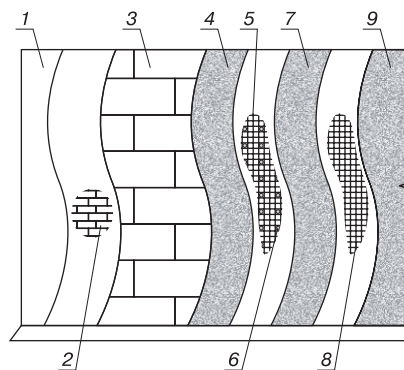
Утепление стены здания по системе «Fassolit Mineral»: 1 – внутренняя штукатурка; 2 – несущая кирпичная стена; 3 – теплоизоляционные плиты марки П-85Г; 4 – выравнивающий слой; 5 – армирующая сетка; 6 – дюбель с шайбой; 7 – выравнивающий слой; 8 – дополнительная армирующая сетка; 9 – отделочный слой
